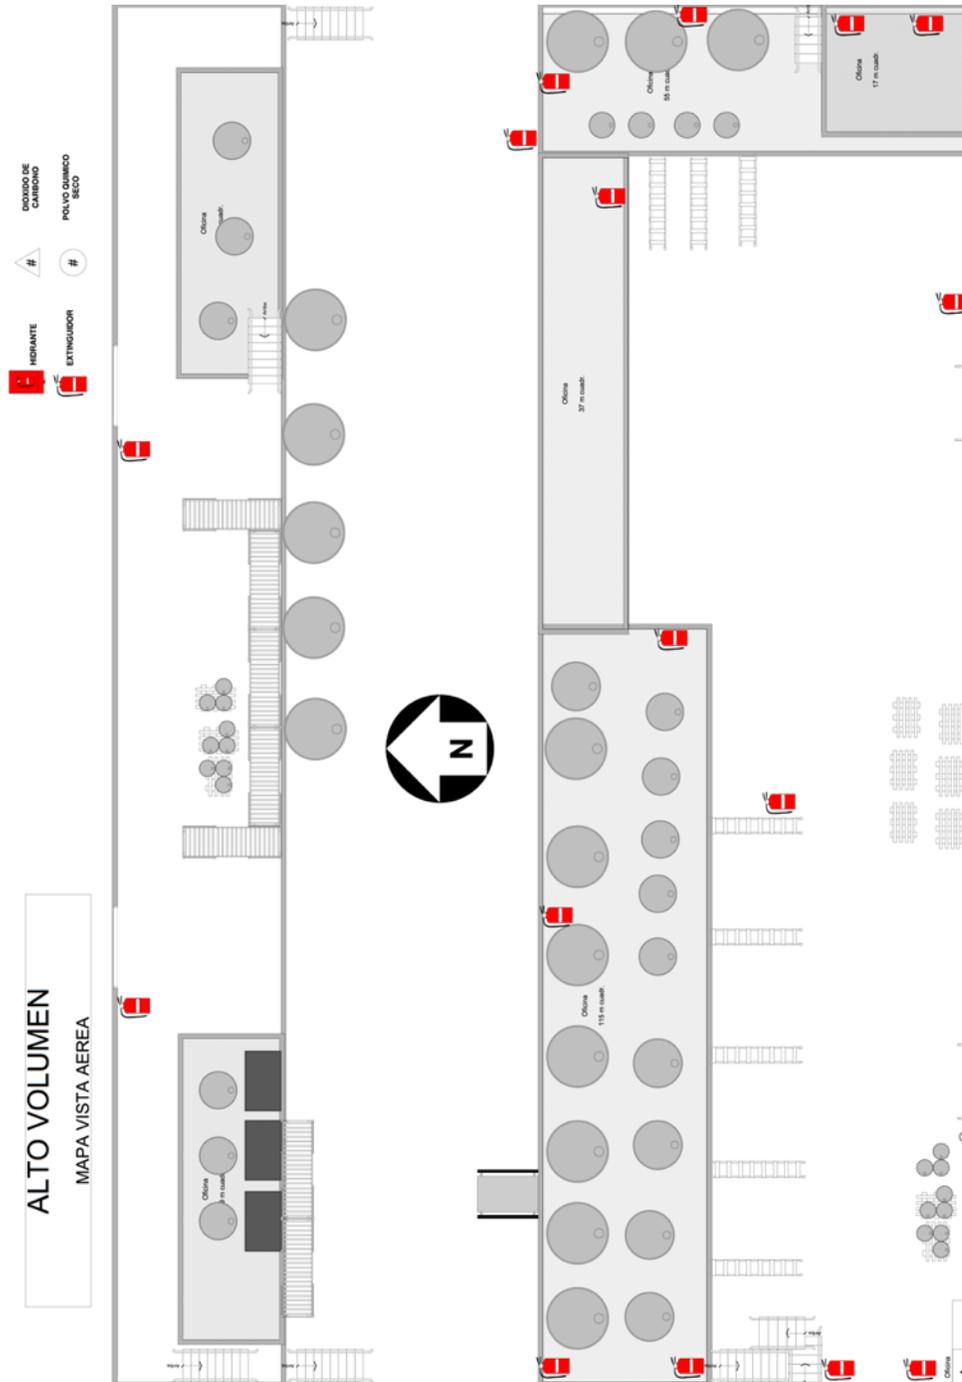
Bosquejo de la Planta Superbia, vista de planta
